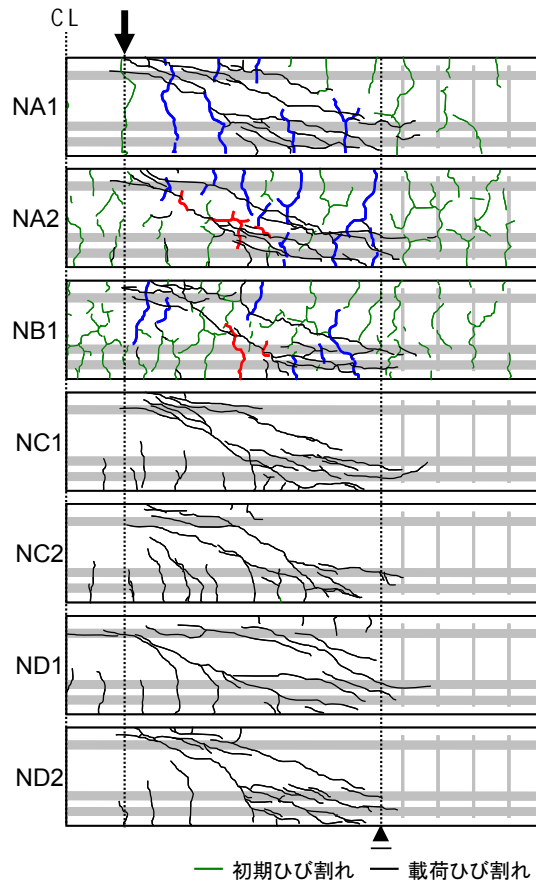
終局時のひび割れ進展状況 (Nシリーズ破壊側)
